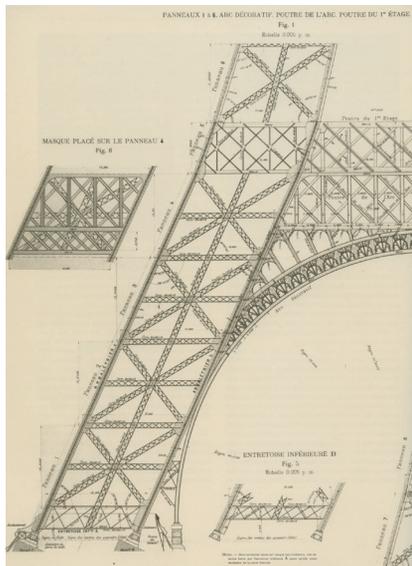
Eiffel, Gustav: Plan eines Pfeilers, Paris 1900.
